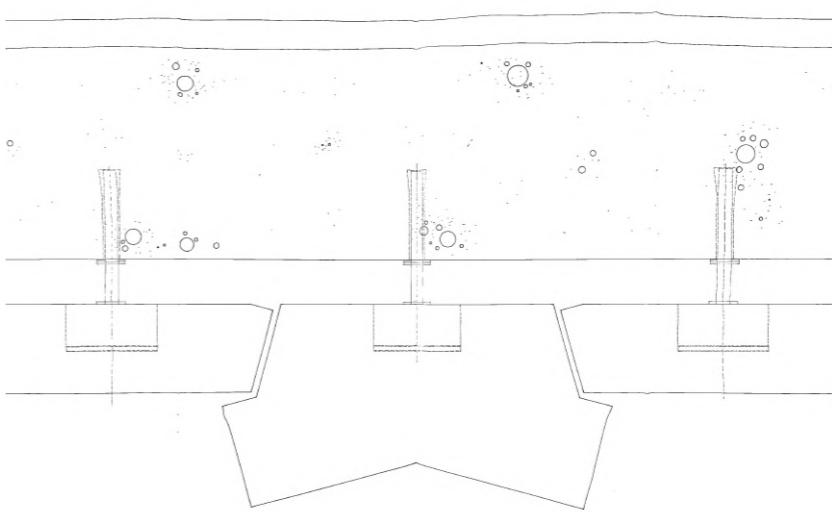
Plan du détail de principe de la façade, esquisse d'un panneau expérimental.
